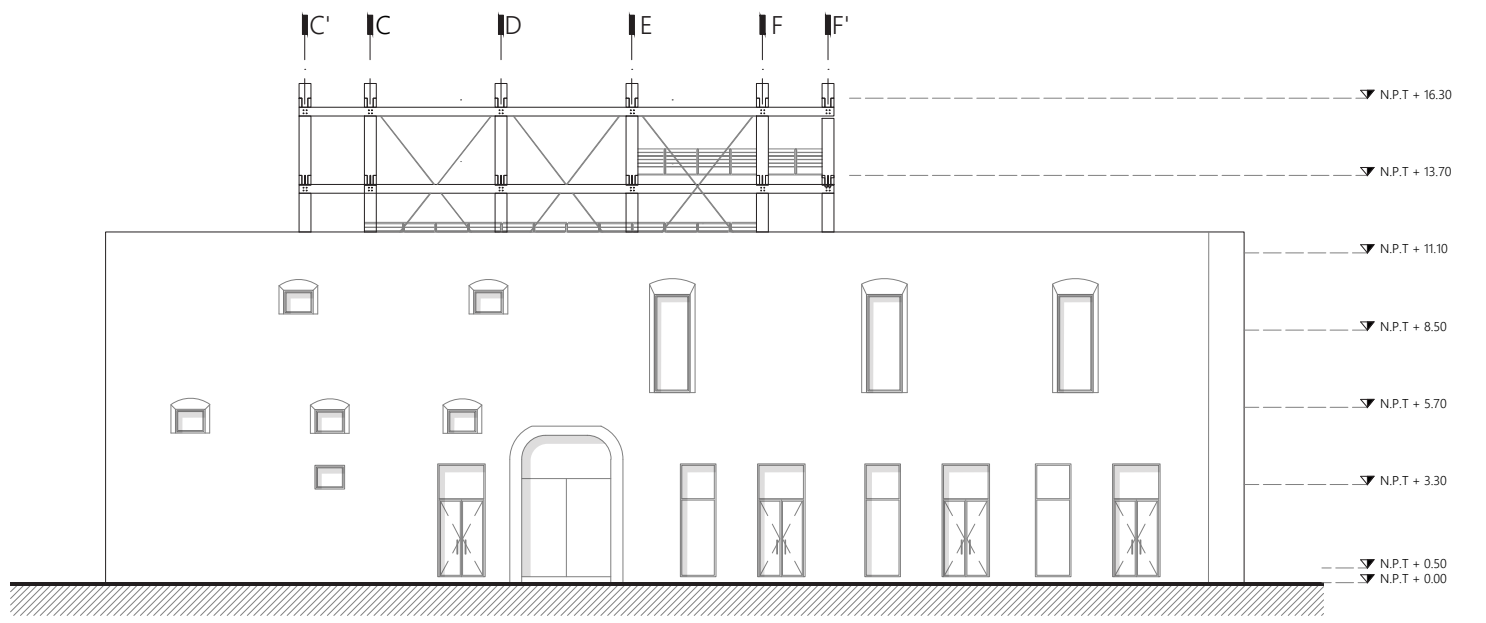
Fachada sur con preexistencia. Fuente: Elaboración propia.
